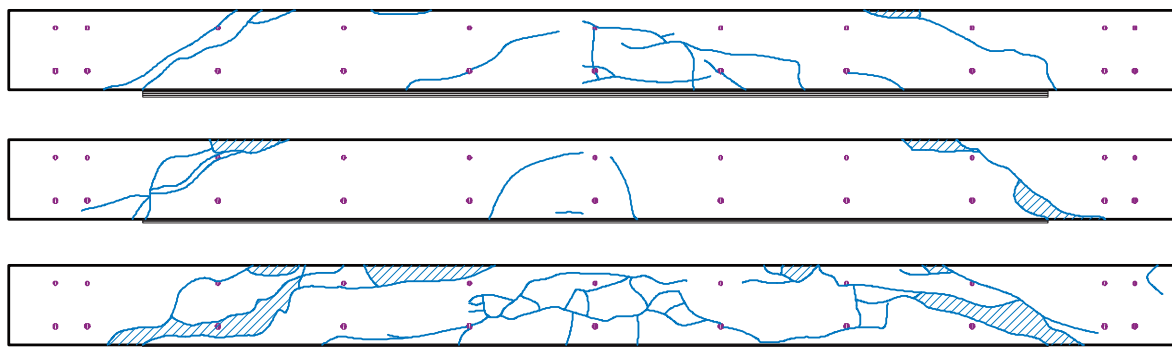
下面接着補強されたRC床版の破壊後の断面観察
